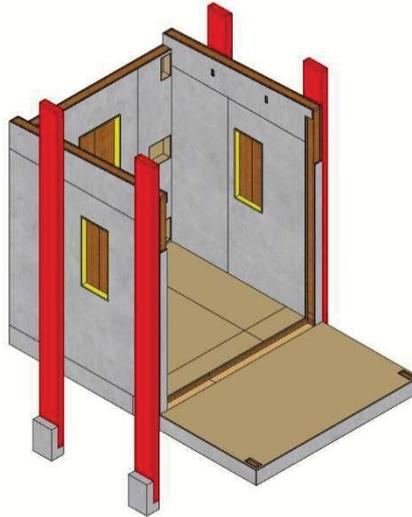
Fixação dos painéis parede (P2A e P2B).
